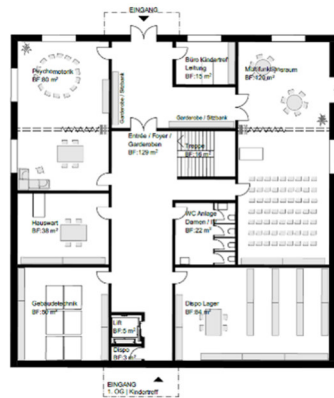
Disposition 04 | Grundriss Erdgeschoss
